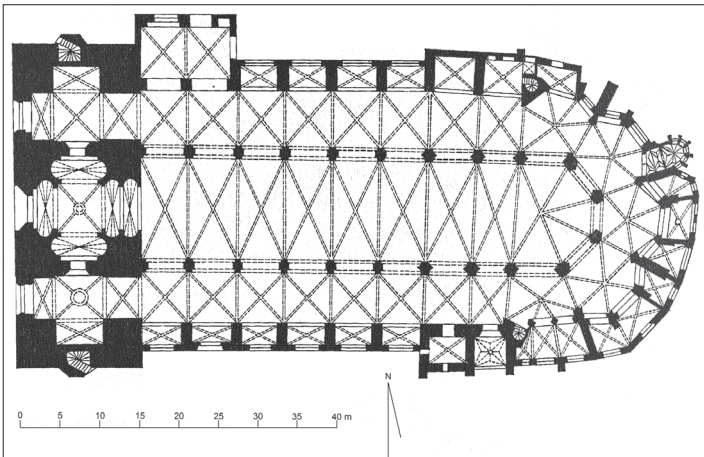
Stralsund St. Nikolai, Grundriss
